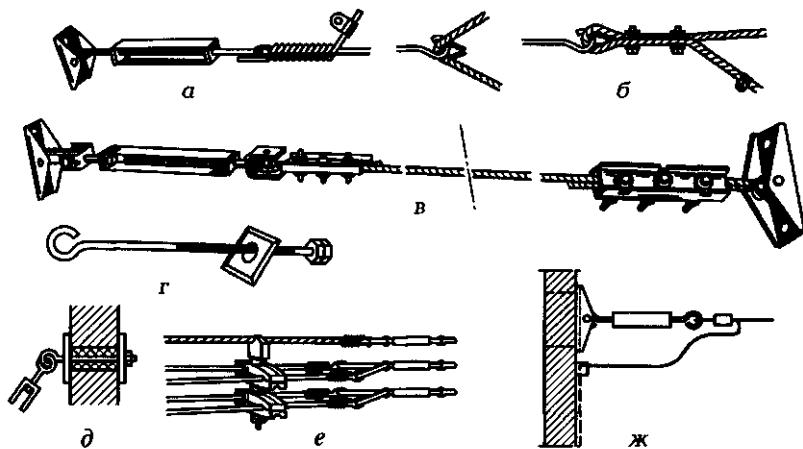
Монтаж элементов тросовых электропроводок:
